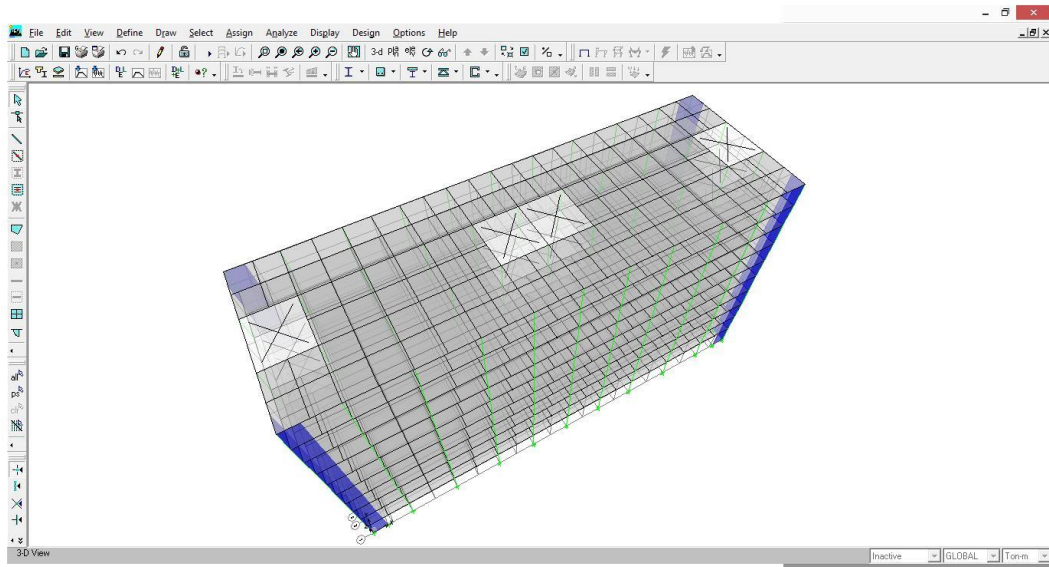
Denah Tampak Samping Arah x Struktur *Shearwall* Model 1
